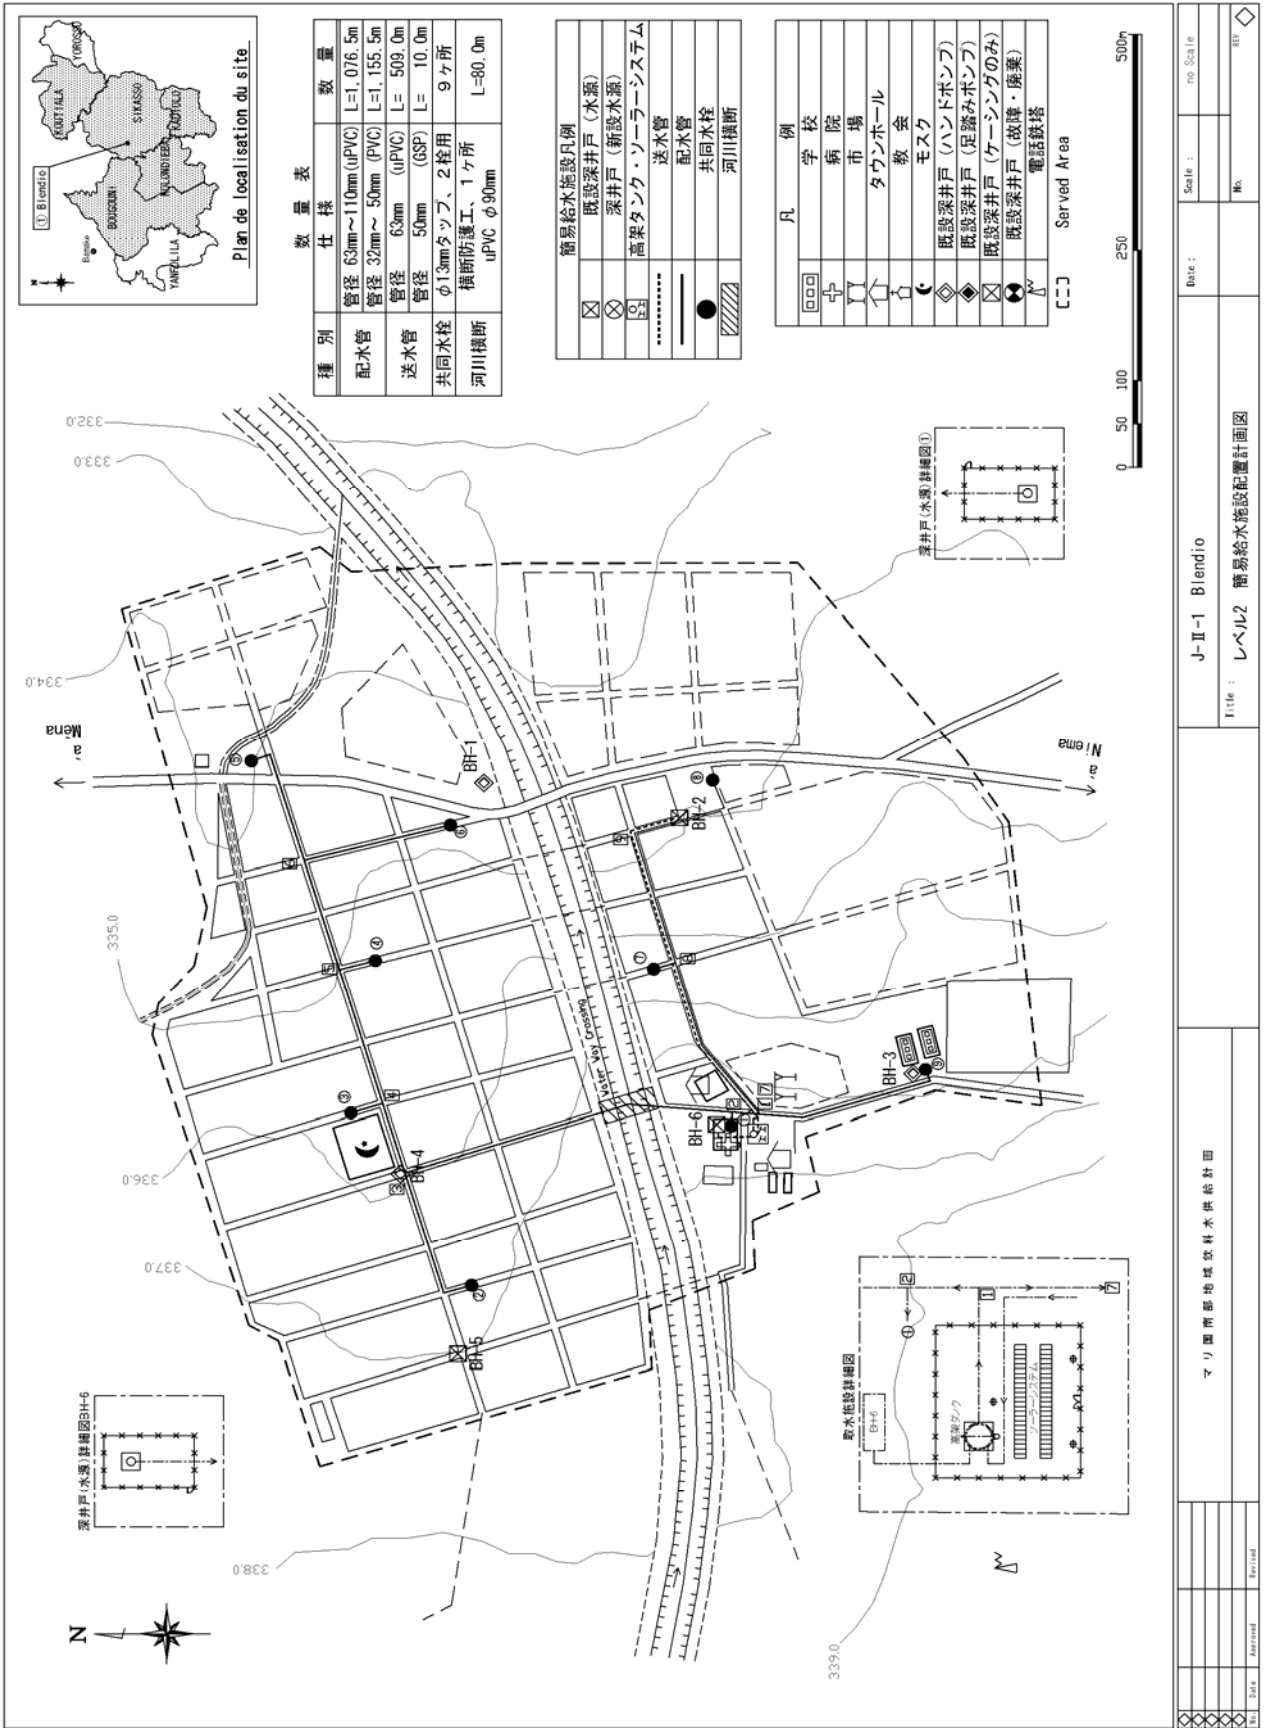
レベル2 給水施設配置図 (J-II-1 Blendio)
